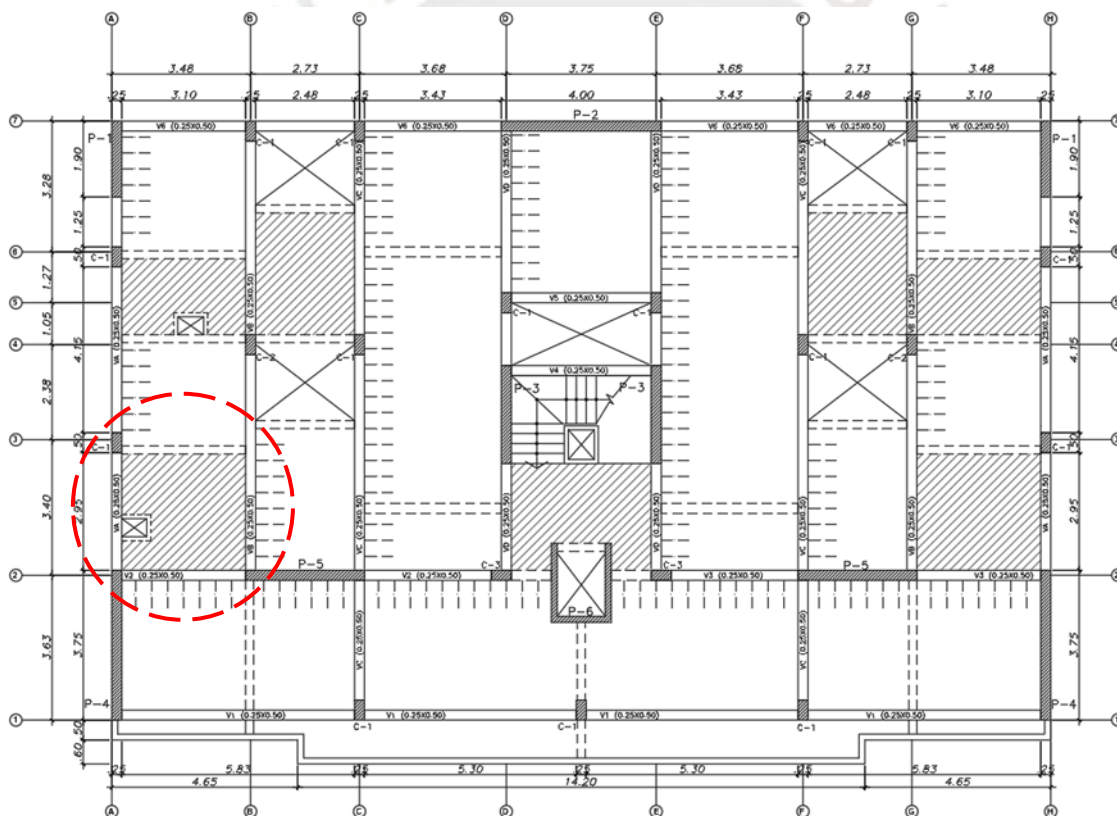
Ubicación en planta de la losa maciza 2-3 y A-B
